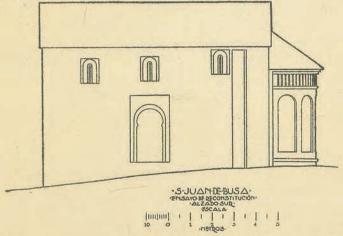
Alzado Sur de la ermita de S. Juan de Busa. Se han supuesto terminadas las ventanas y elevada la cubierta.
